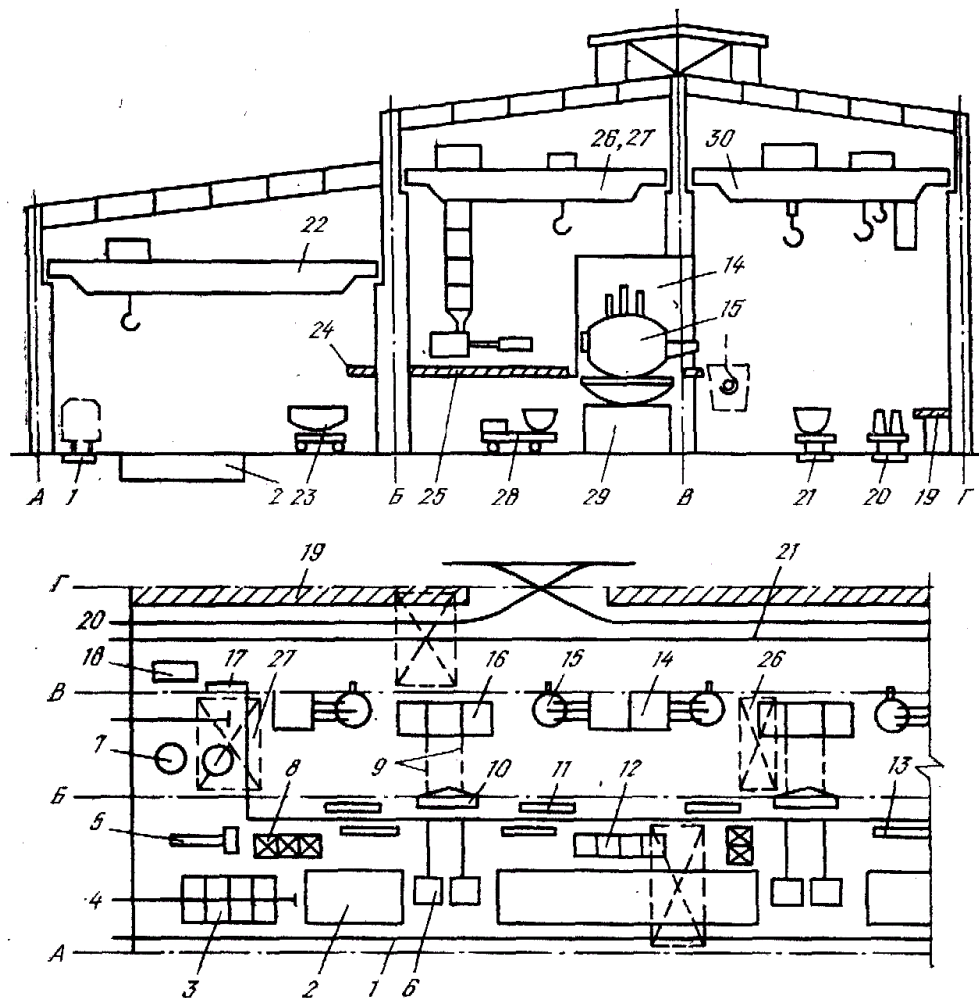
План и поперечный разрез электросталеплавильного цеха А
